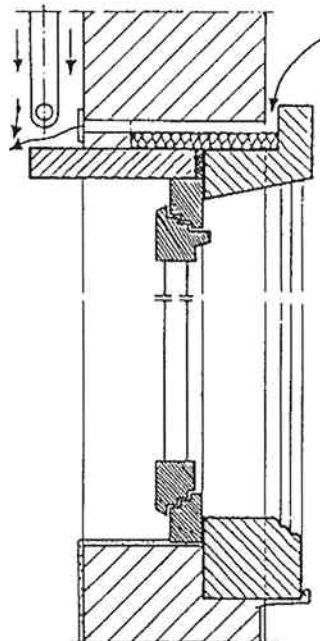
Zuluffführung in einem denkmalgeschützten Barockgebäude
